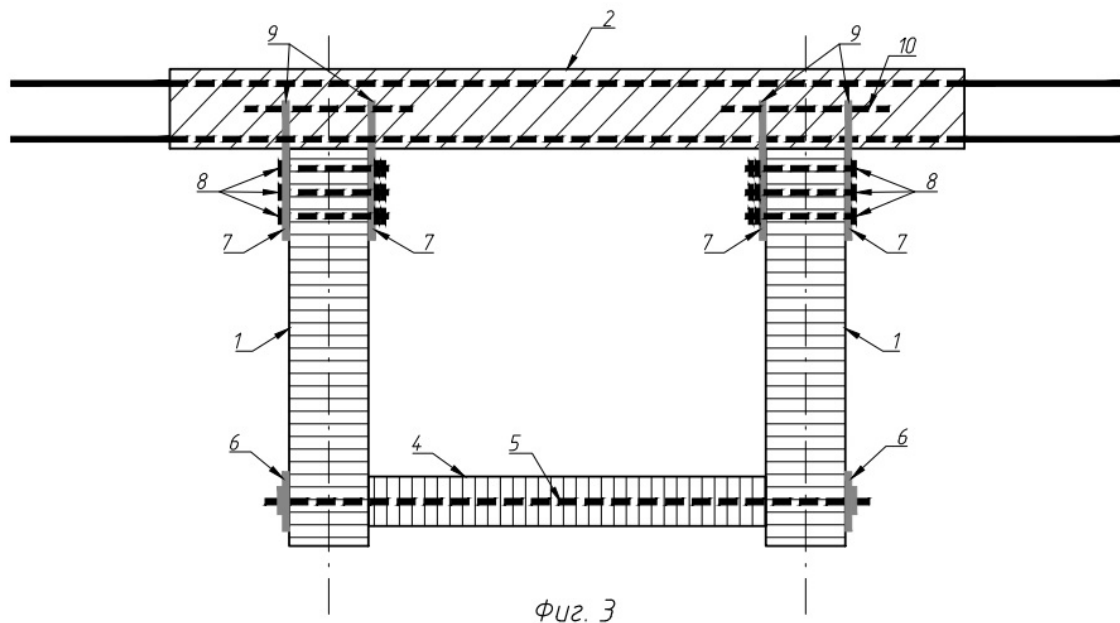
Поперечное сечение деревобетонной секции пролетного строения с узлом объединения ж.б. плиты и клееных балок. Узел В-В
